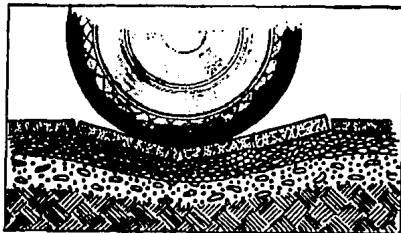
Falla por compactación deficiente en un pavimento rígido.
